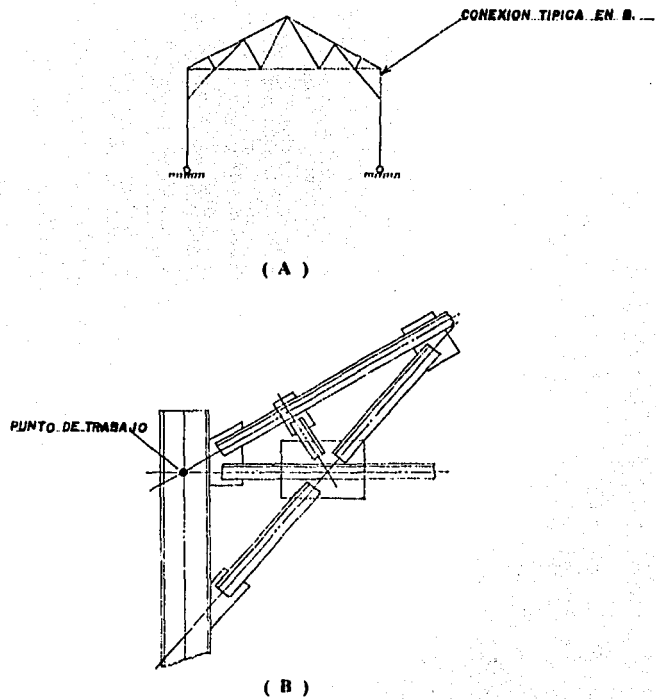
Marco articulado en la base y empotrado en la unión viga columna.
